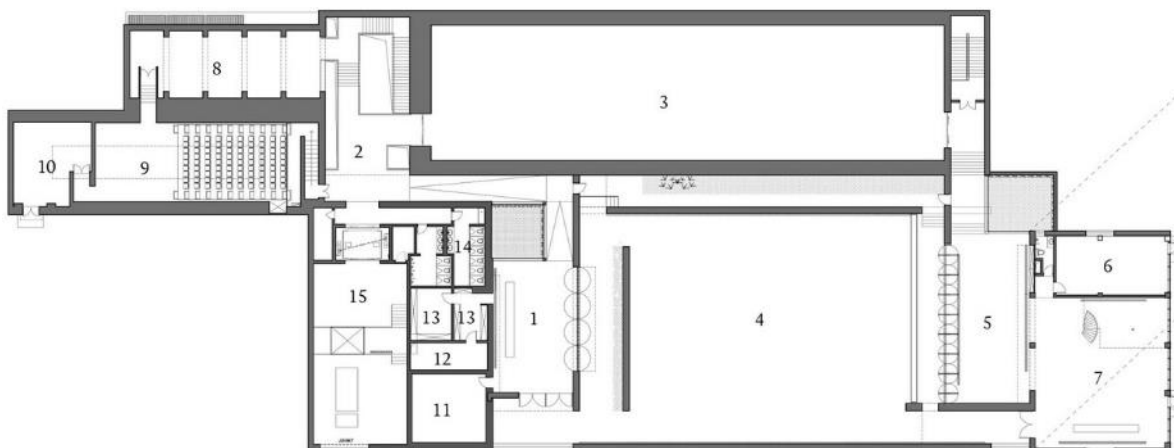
Planta baja arquitectónica del Museo de Arte CUBE en 798. Shuangyu, H. (17 de septiembre 2022).
